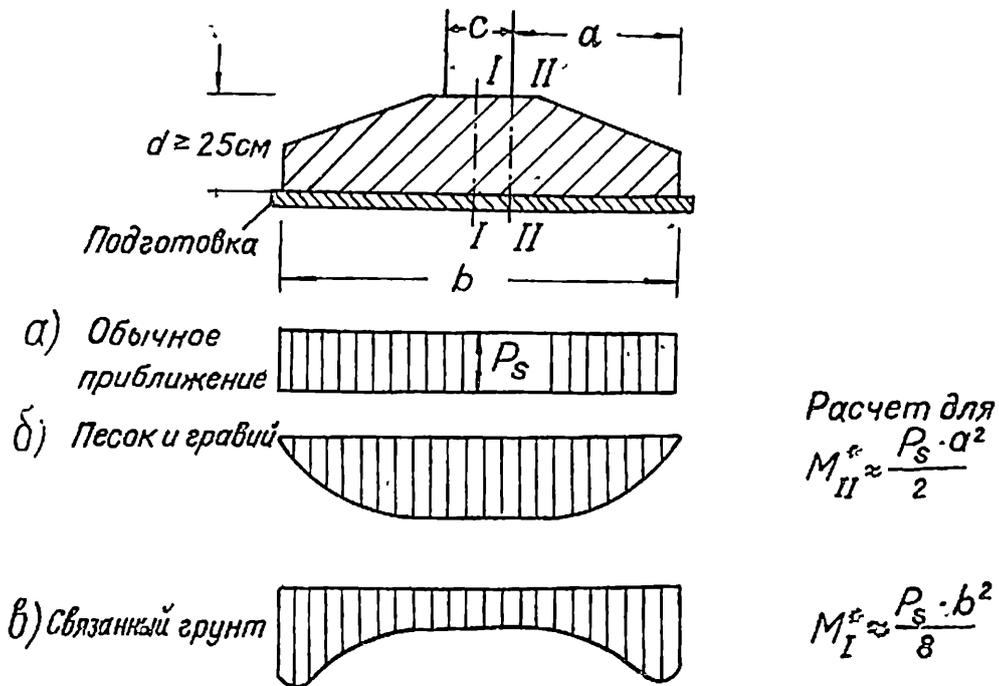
2. Давление на грунт при ленточных фундаментах
